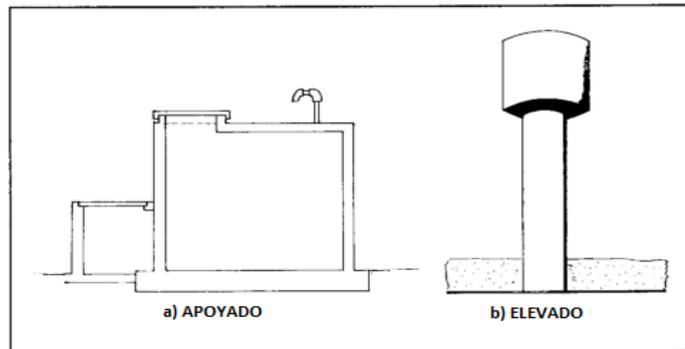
Tipos de Reservorio Apoyado y Elevado. Fuente: Agüero, 1997.
